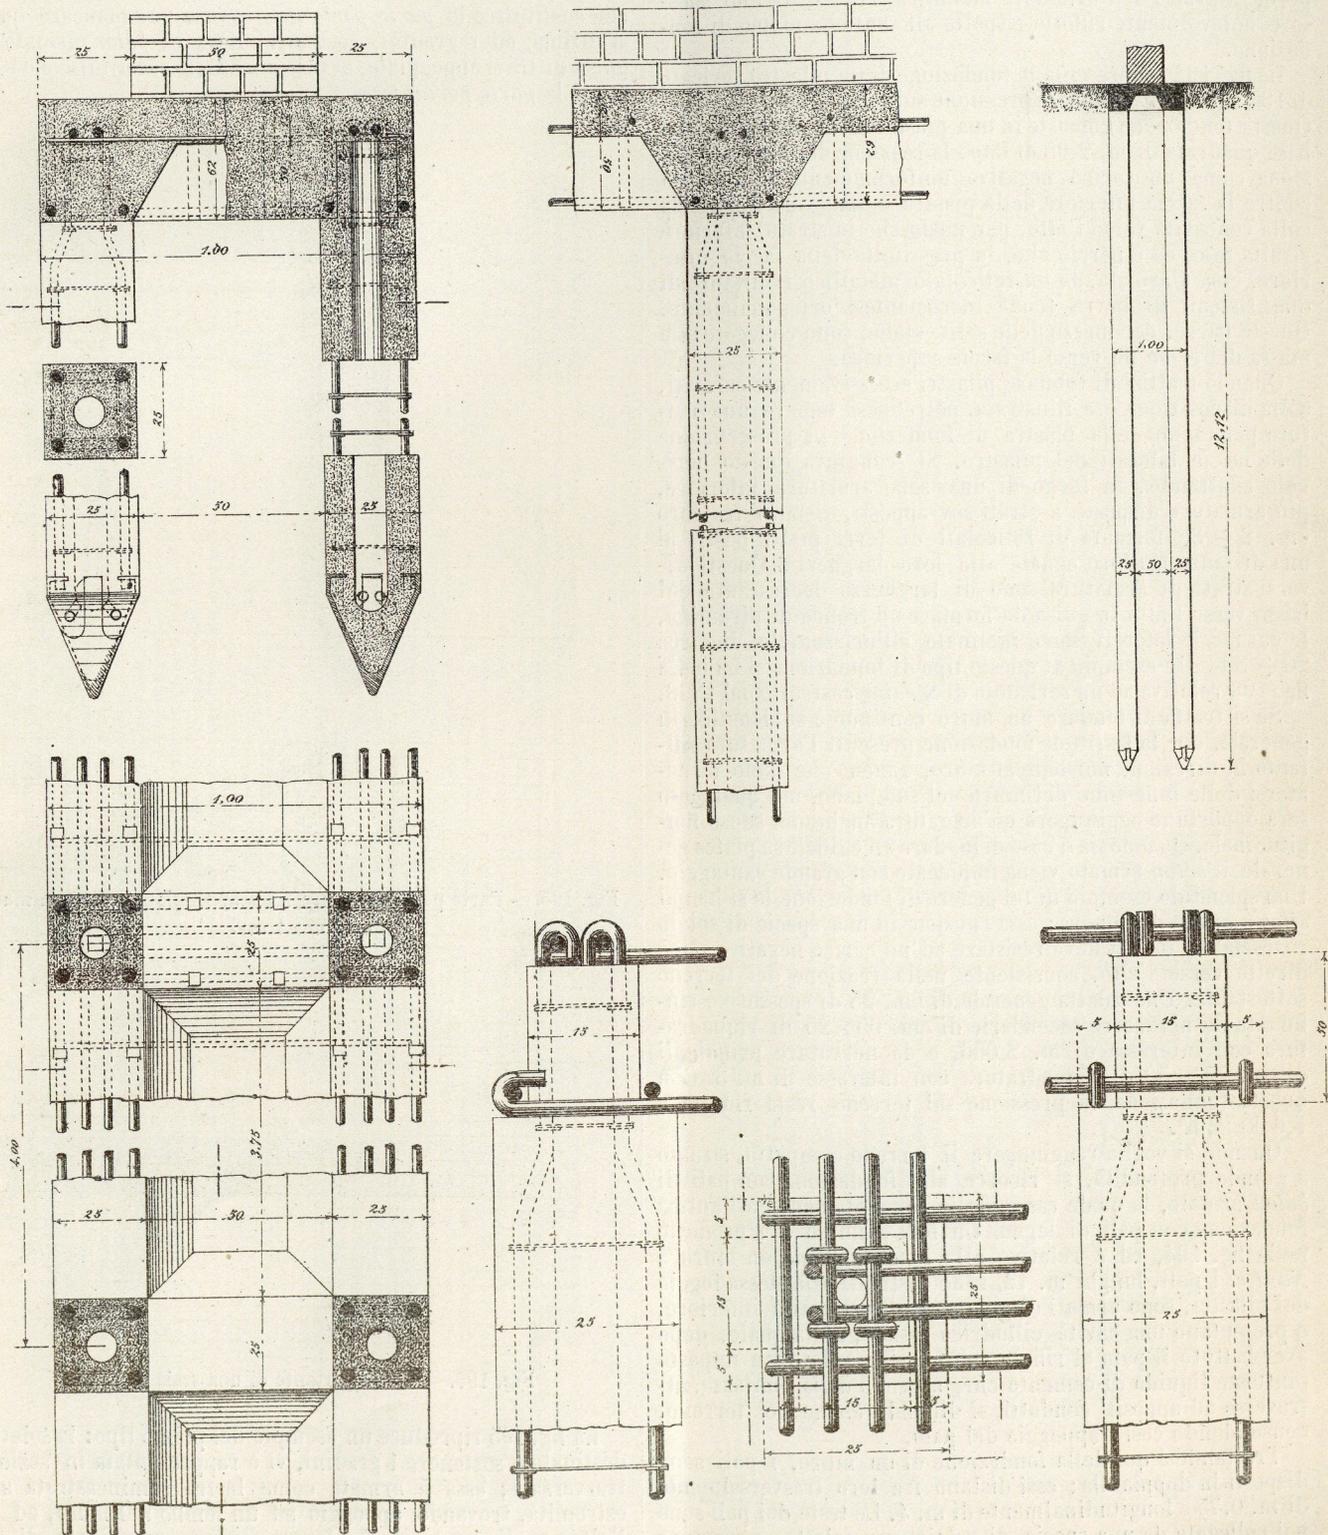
Particolari di fondazione su pali di un muro a Nantes.
